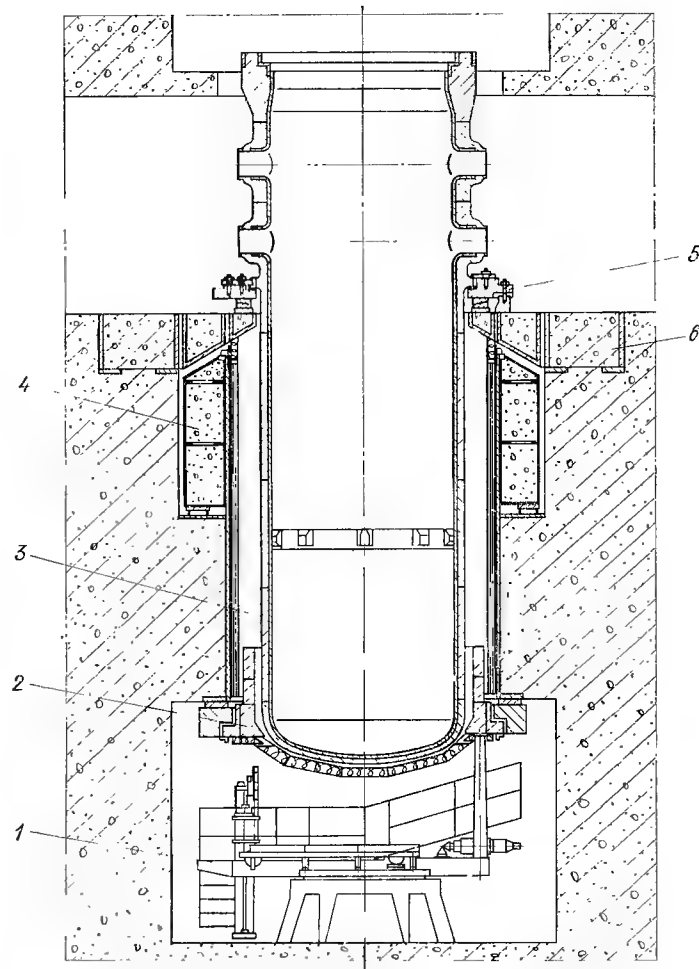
Установка опоры корпуса и корпуса реактора ВВЭР-440.
